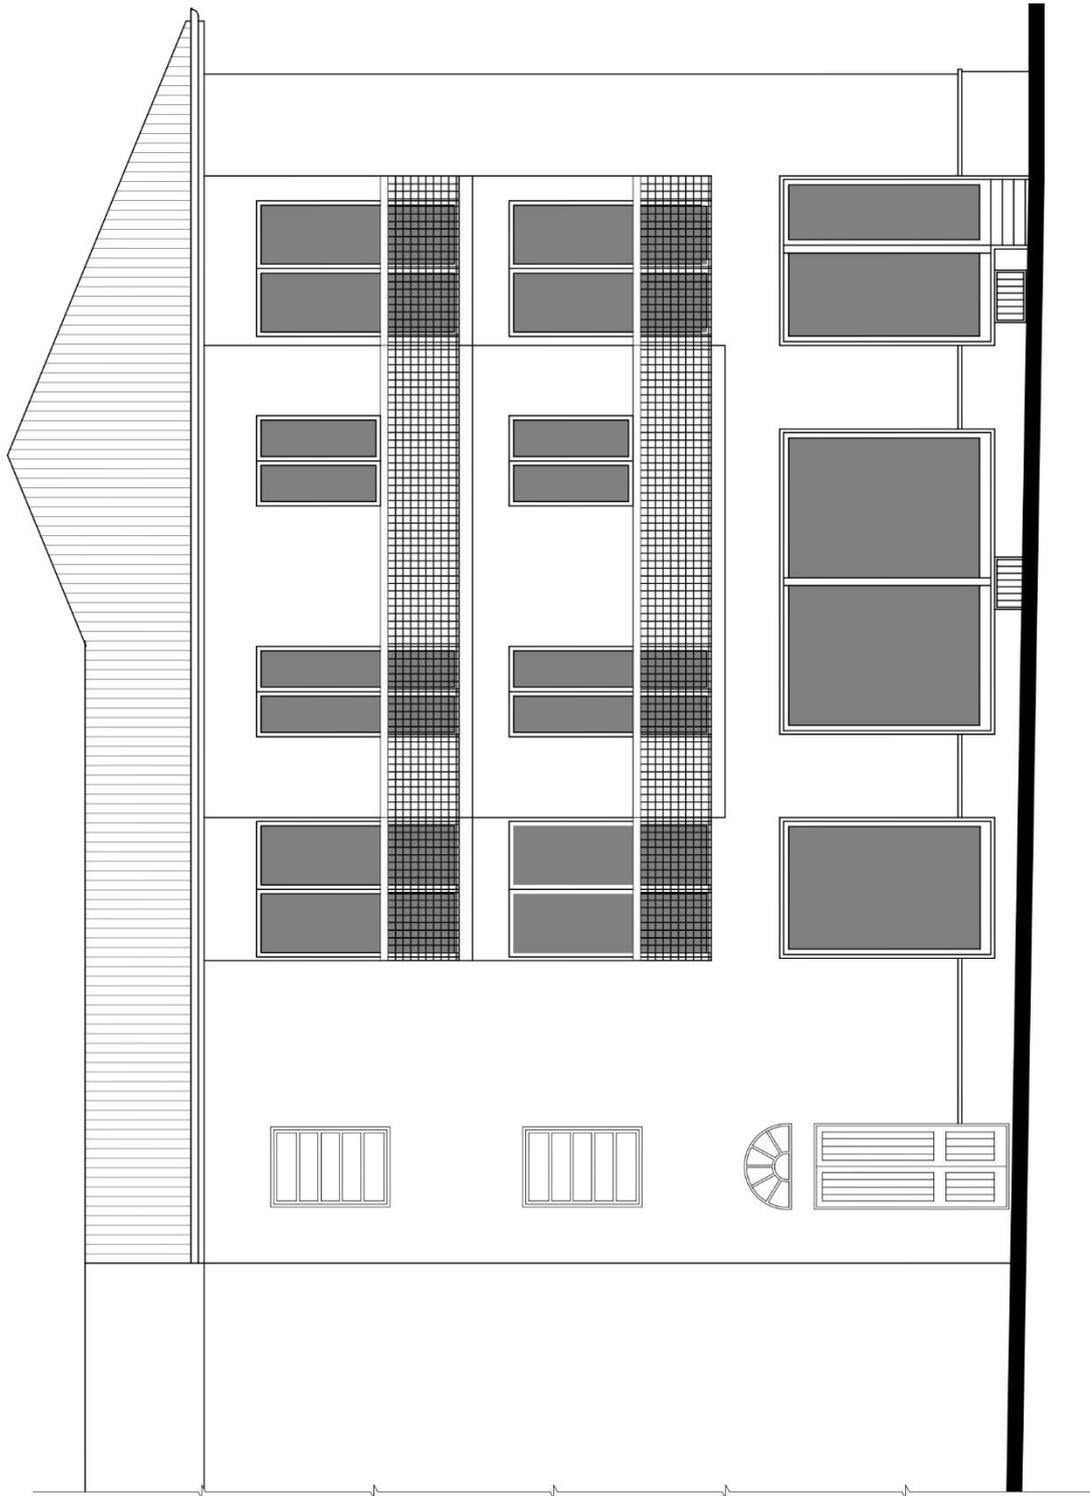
Alternativa progettuale con appartamento A con due camere singole
